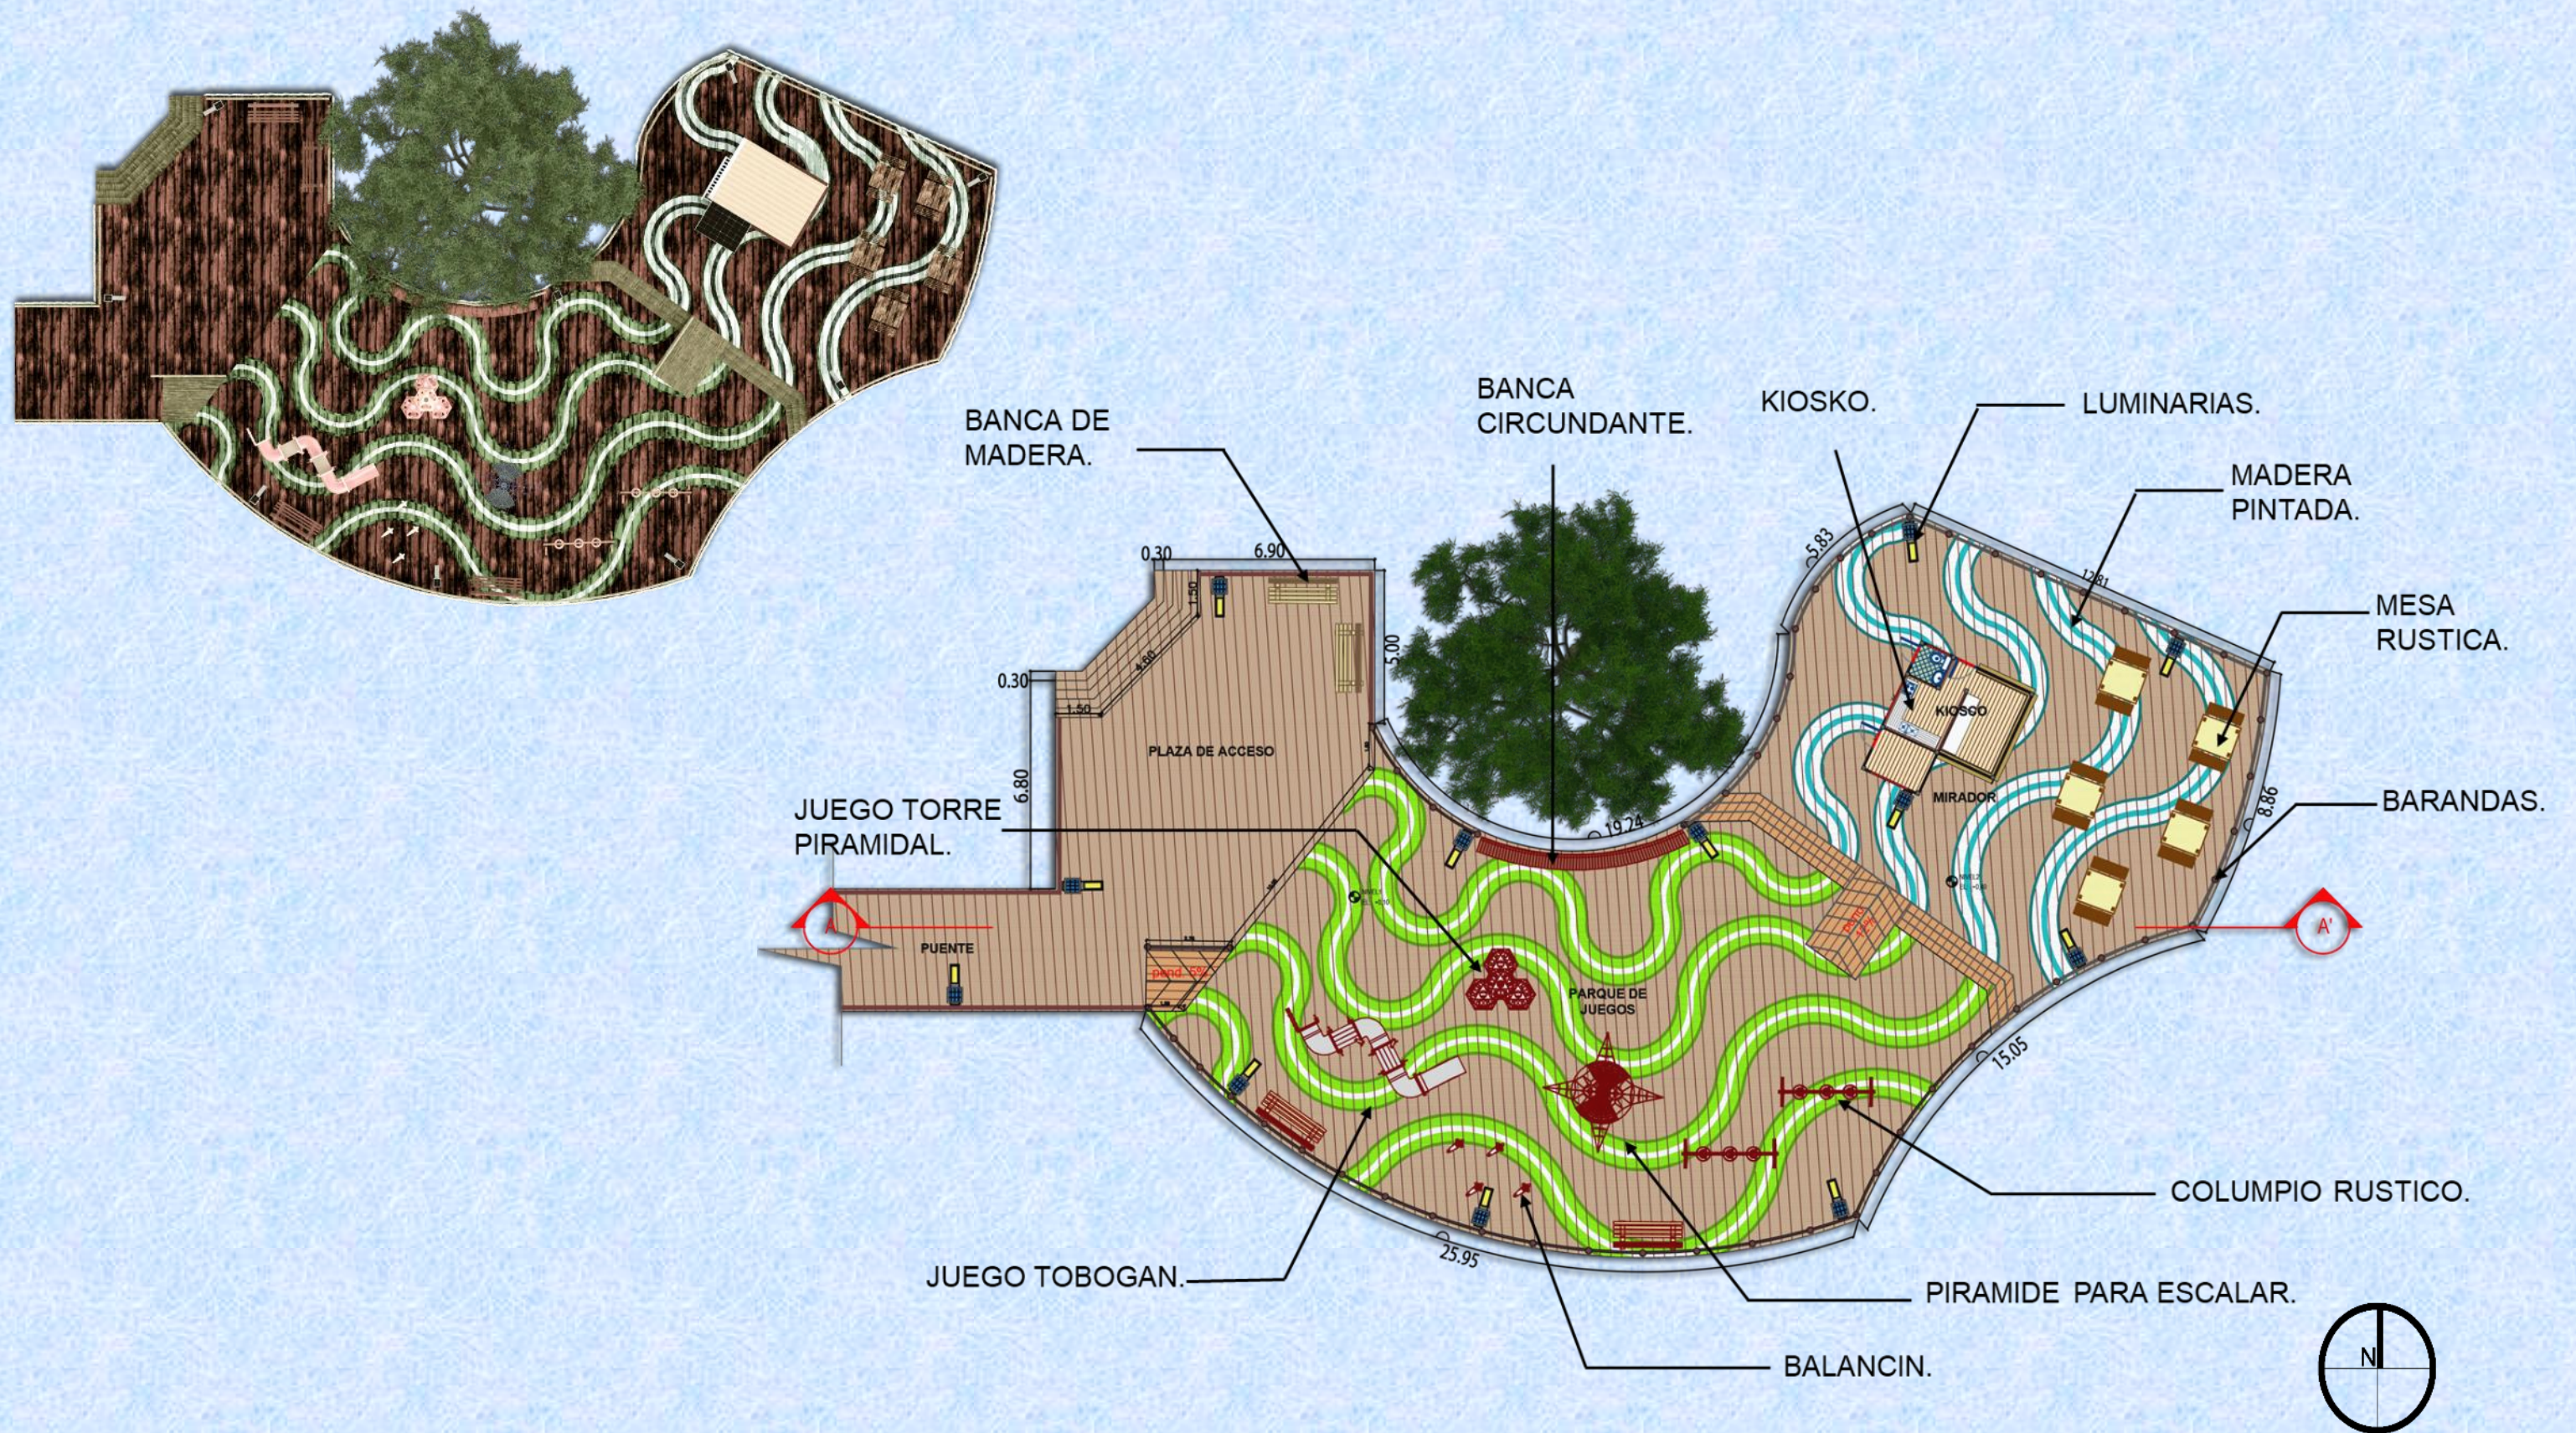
Implantación y planta parque y mirador. Fuente: Elaboración propia
